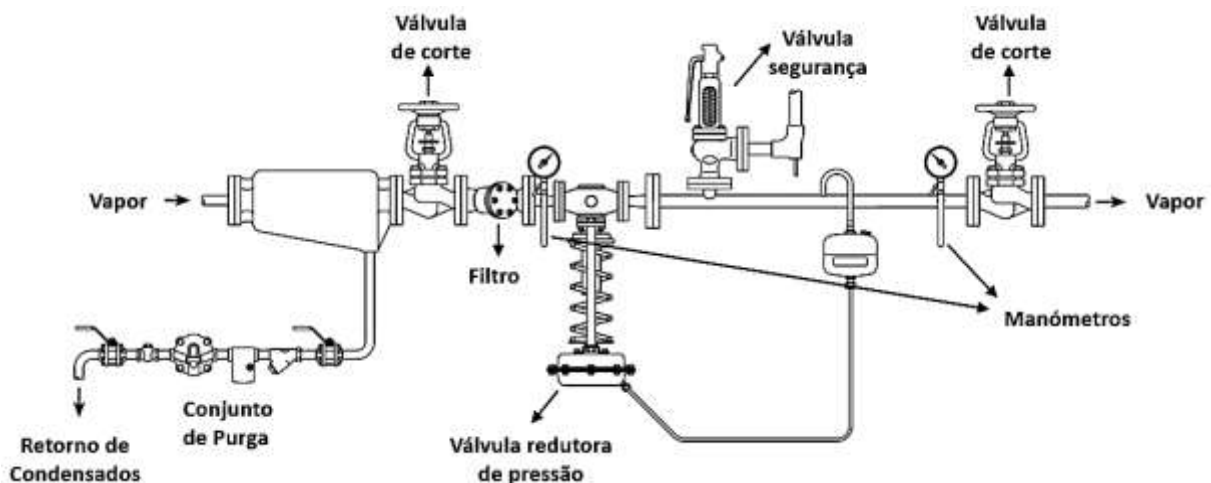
Conjunto redutor de pressão ideal. Adaptado de [2]
